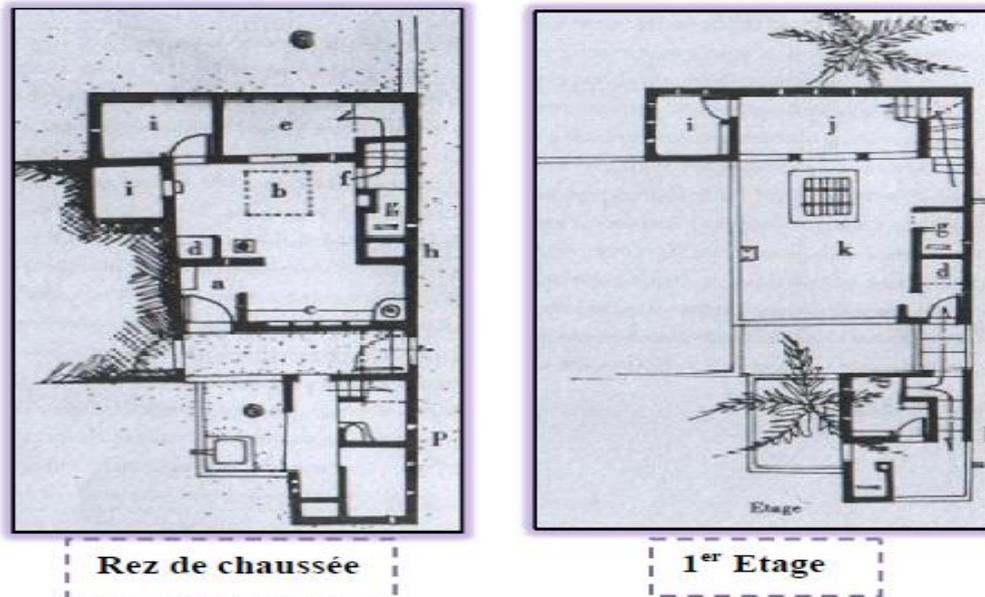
Plan d'une maison du M'Zab (palmeraie)
